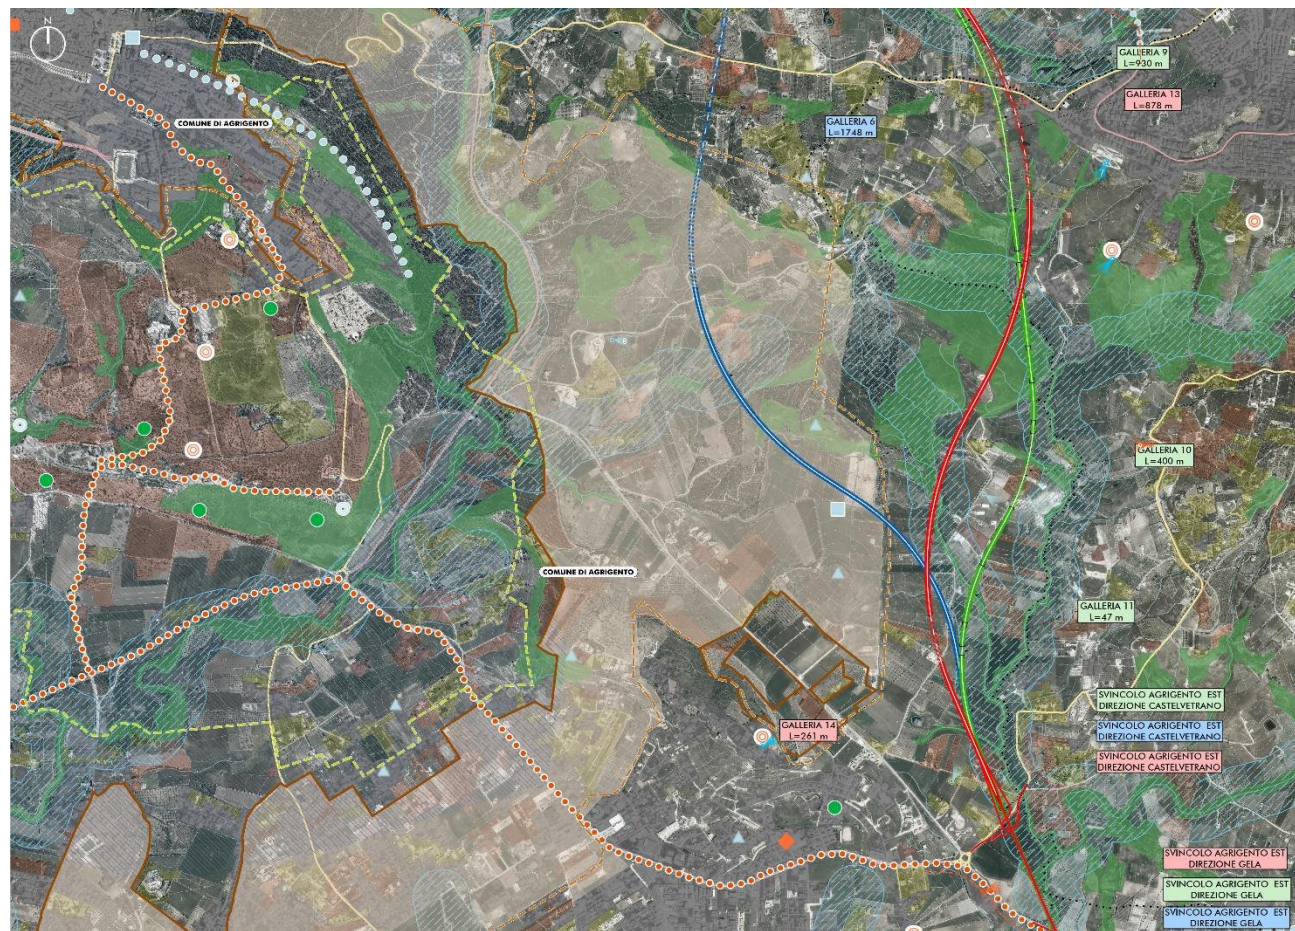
Stralcio planimetrico delle 3 alternative nella zona est con individuazione degli ambiti di paesaggio interessati
